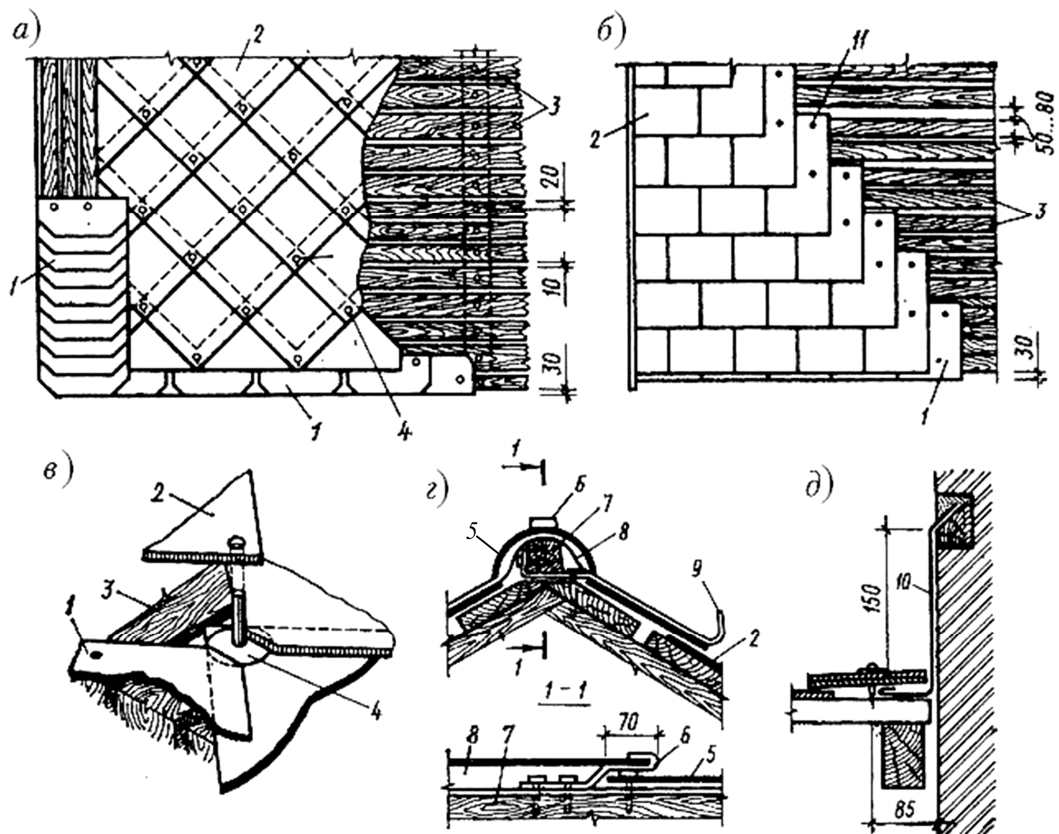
Кровля из плоских асбестоцементных плиток:
